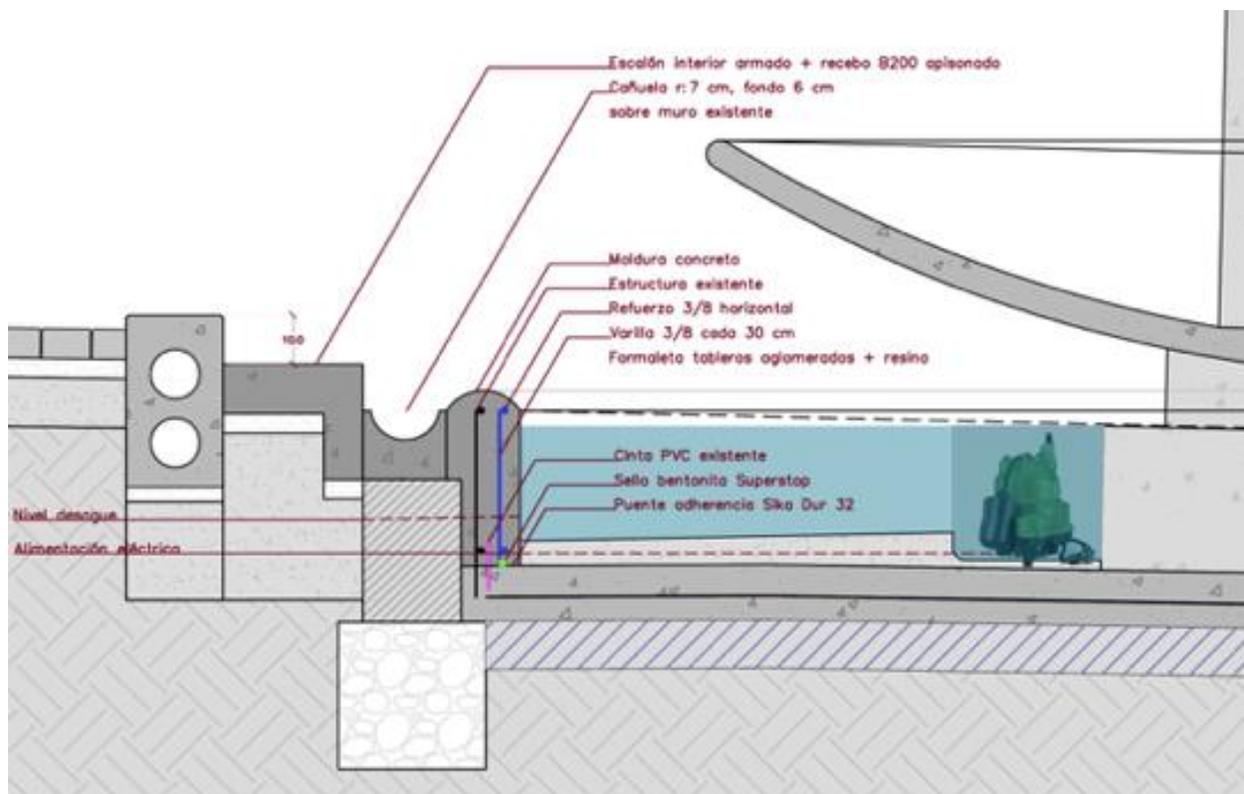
Detalle constructivo en Corte de readecuación de pileta y sistema hidráulico
